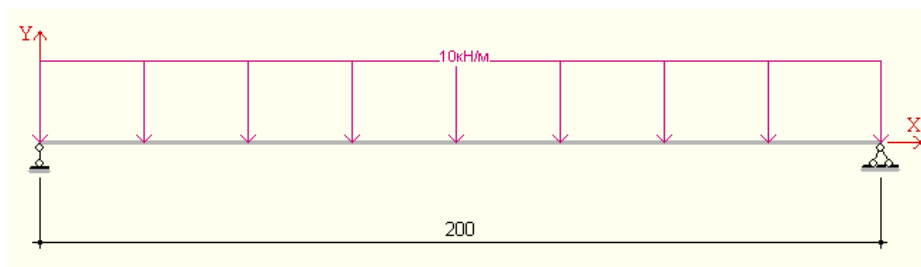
Расчётная схема балки по Заданию 3.1
